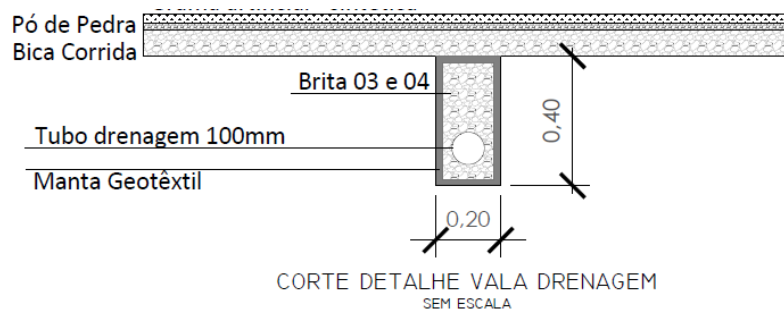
Detalhe de instalação Drenagem (Fonte: Autor/2024)
